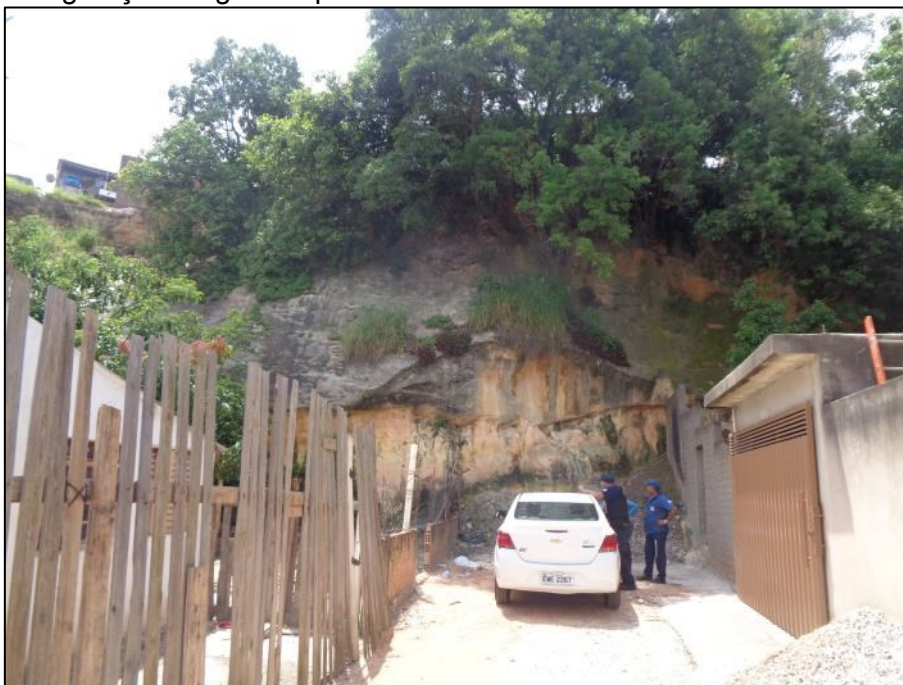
Vista parcial da área. Notar a via pavimentada com bloquete.
